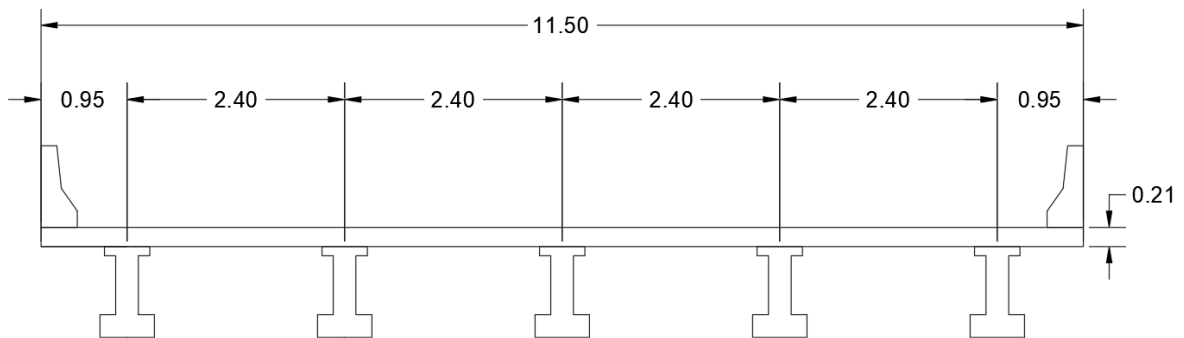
Seção transversal do tabuleiro da ponte em concreto armado (dimensões em metros).
